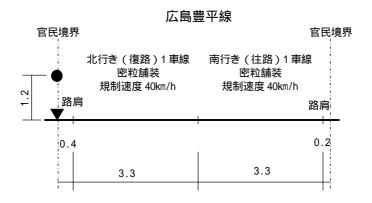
(2) 騒音・振動発生機器配置図(立面図)
